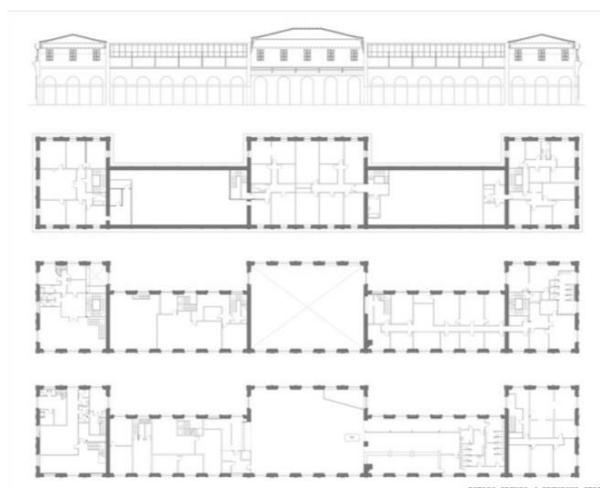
Fachada e plantas originais da Estação de Burgos. A proposta de intervenção retirou as paredes de divisão de ambientes para criar um espaço contínuo e fluído. Fonte: : Acervo site Archdaily. Acesso em Junho/2018
